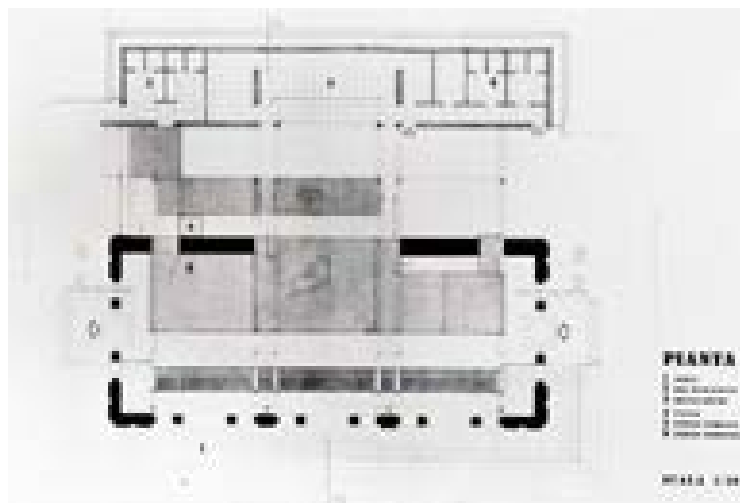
Pianta del piano terra allegata al plastico del progetto definitivo (AABS)
